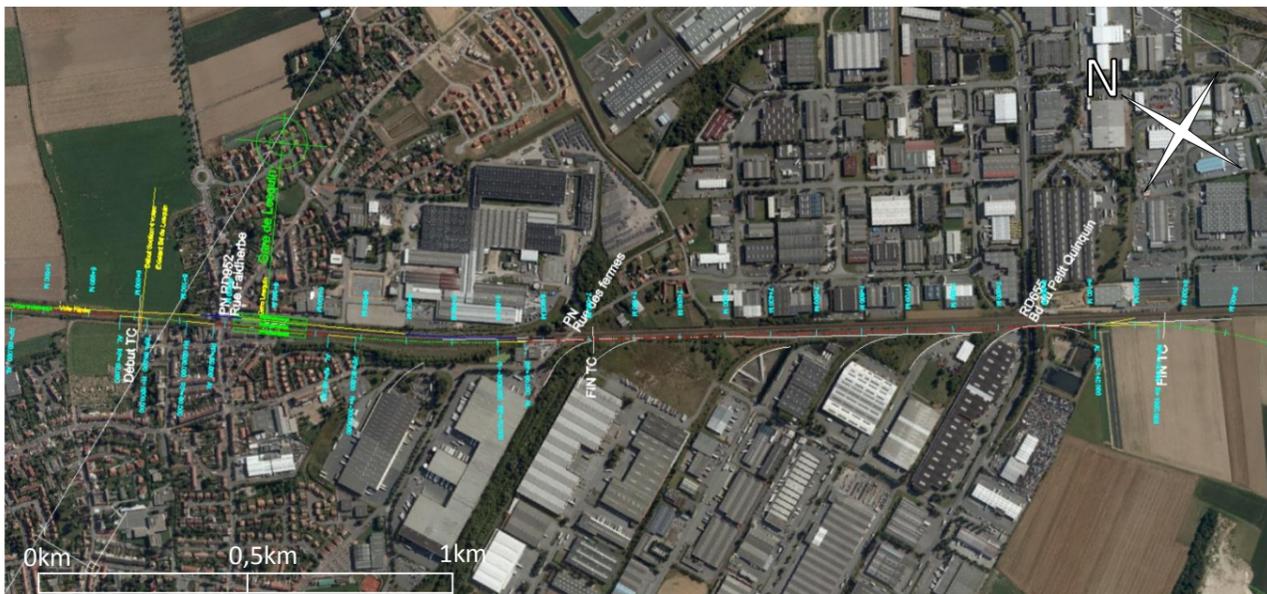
Traversée de Lesquin en souterrain : Implantation en plan et en profil du tracé de référence
